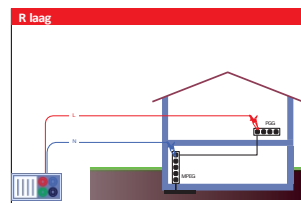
Aansluitschema voor lage impedantiemeting (R_{low}) – LOW
